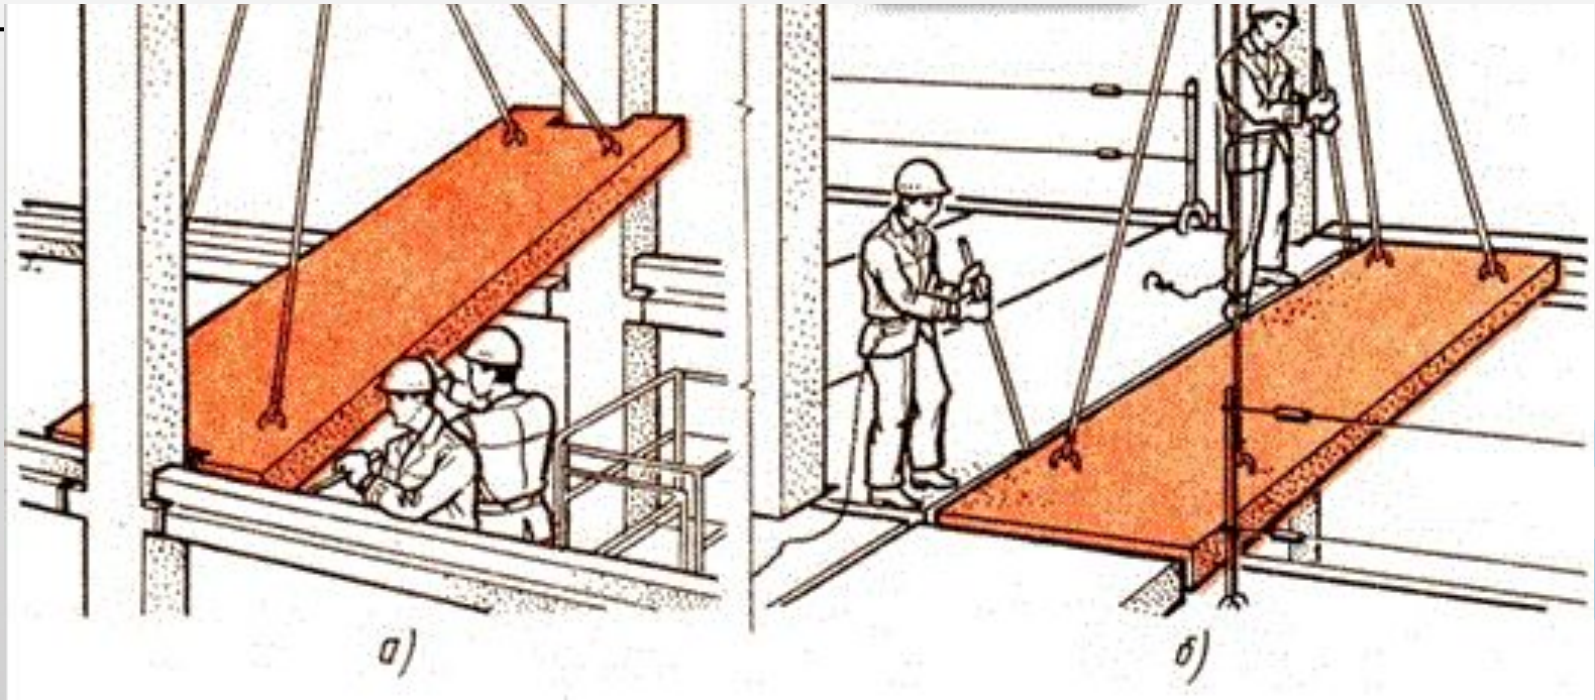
Укладка связевой (распорной) (а) и рядовой (б) плит перекрытия
